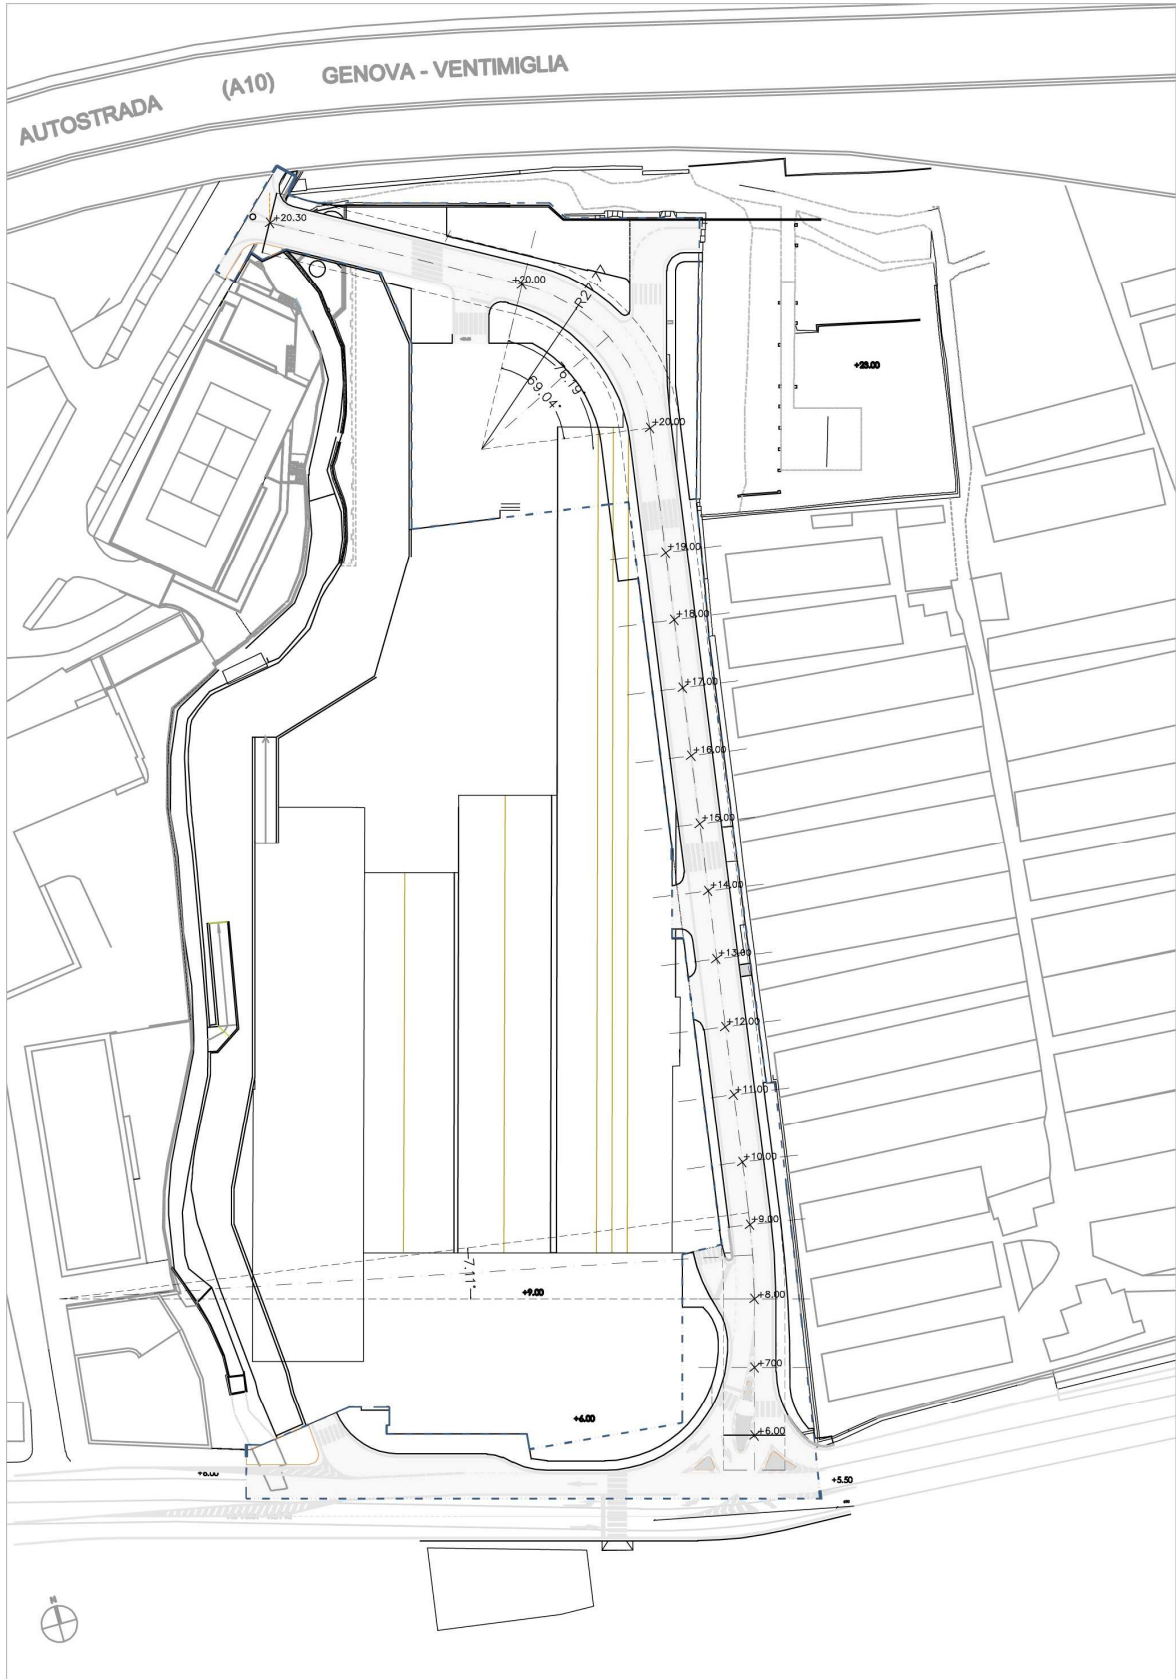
planimetria del nuovo tracciato stradale previsto dal PUO.
